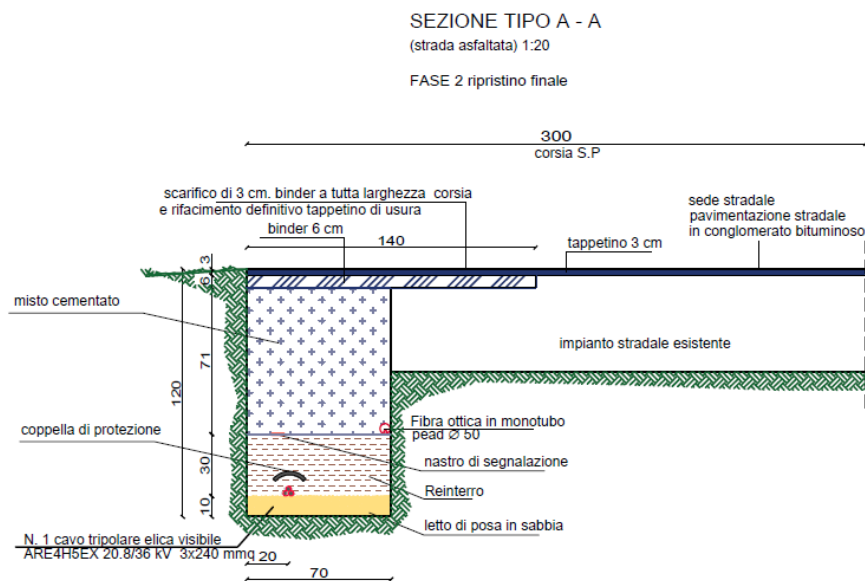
sezione del cavidotto posato lungo strada asfaltata.
